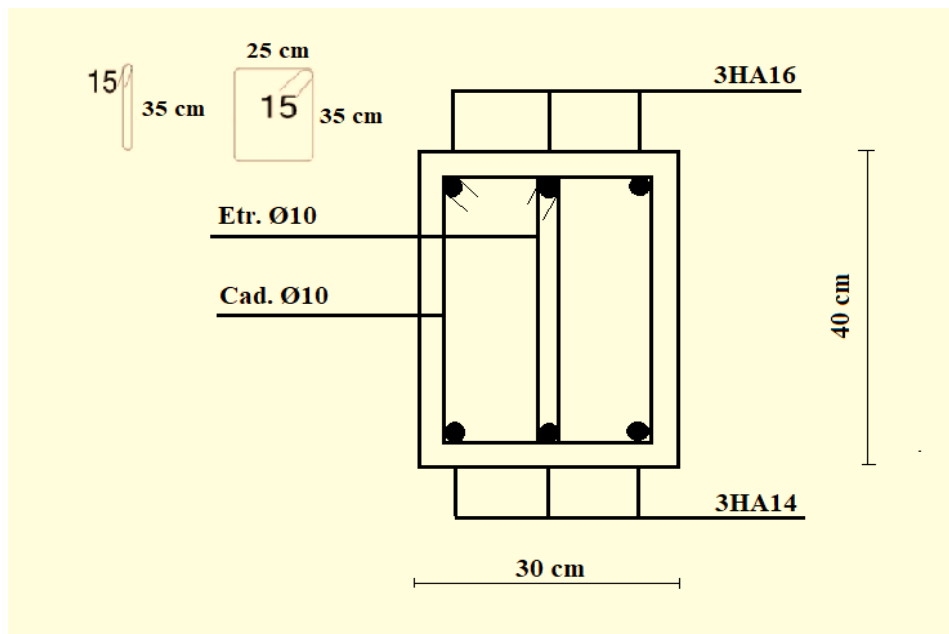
Ferrailage des poutres secondaire au niveau d'appuis pour 7^{ème} ; 6^{ème} ; 5^{ème} ; 4^{ème} ; 3^{ème} étage
